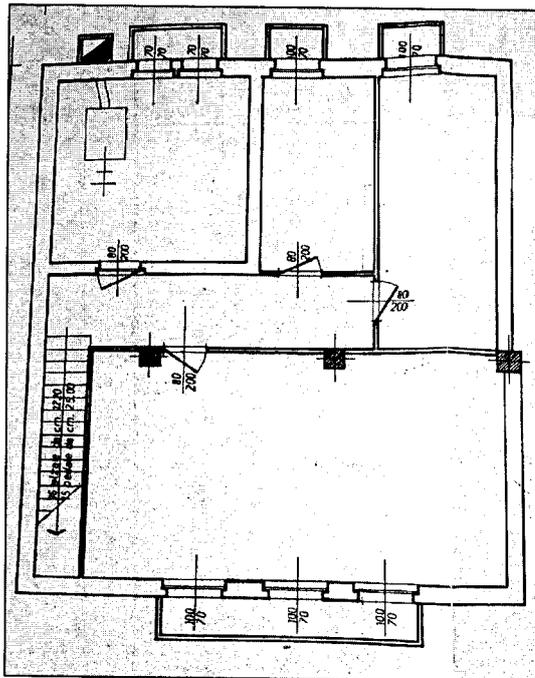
Estratto planimetria L.E. 11.01.1966 P.S1
